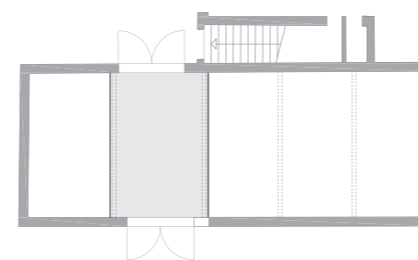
Grundriss des Querscheune des Entwurfsobjektes
